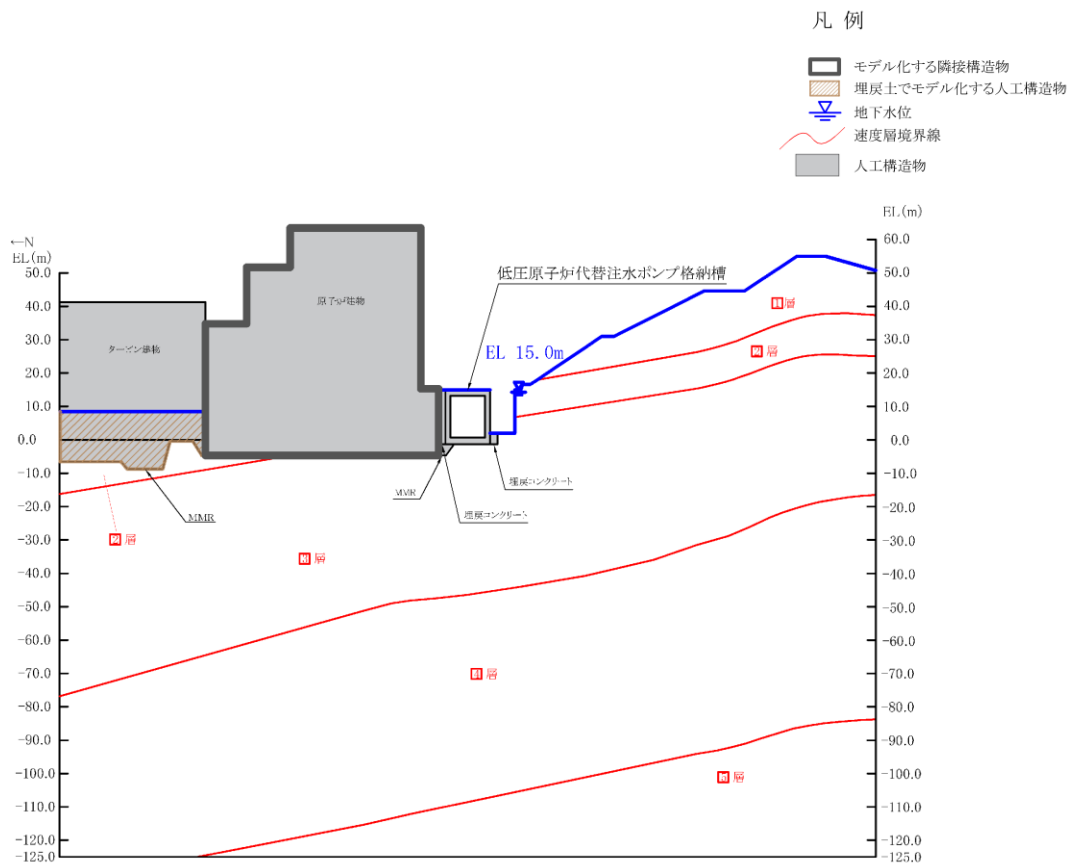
低圧原子炉代替注水ポンプ格納槽 評価対象断面図 (B-B 断面位置)
